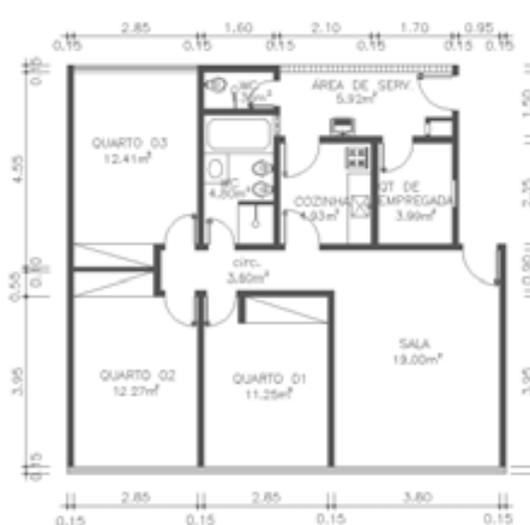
SQS 413 – Bloco S – Planta Original
